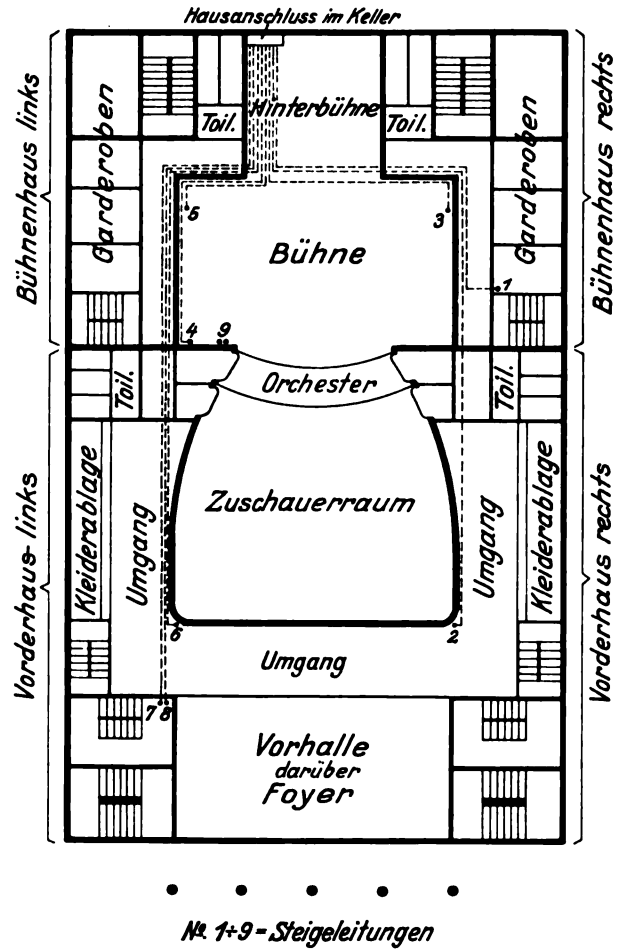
Grundrißbeispiel eines Theatergebäudes mit eingezeichneten Hauptleitungen.
